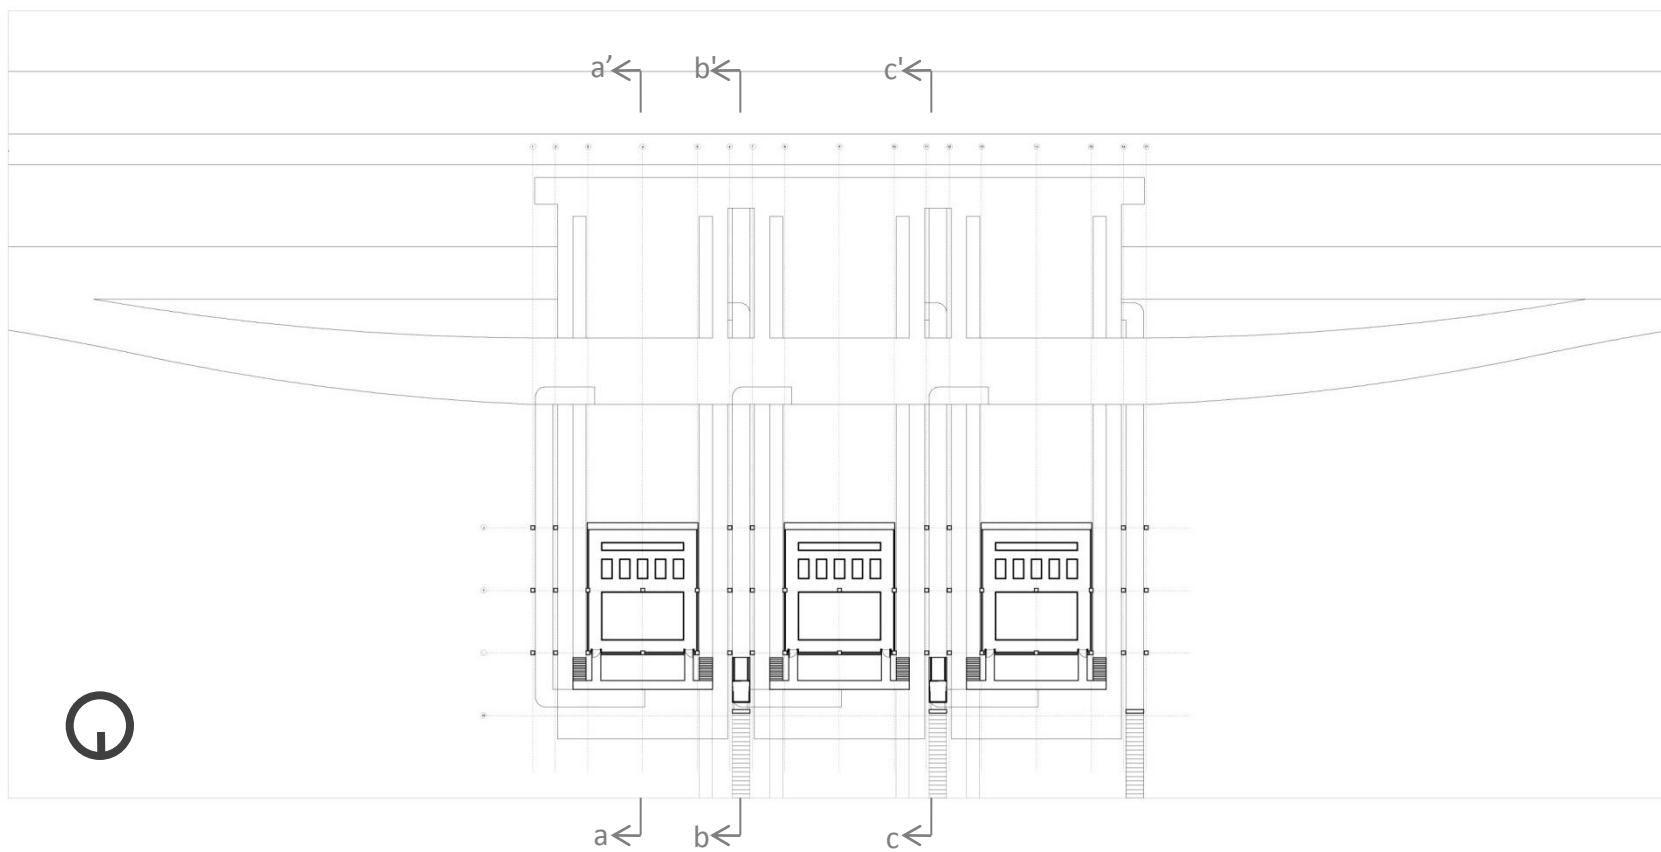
Planta nivel -5_ Salas de generadores de electricidad. esc 1:800
